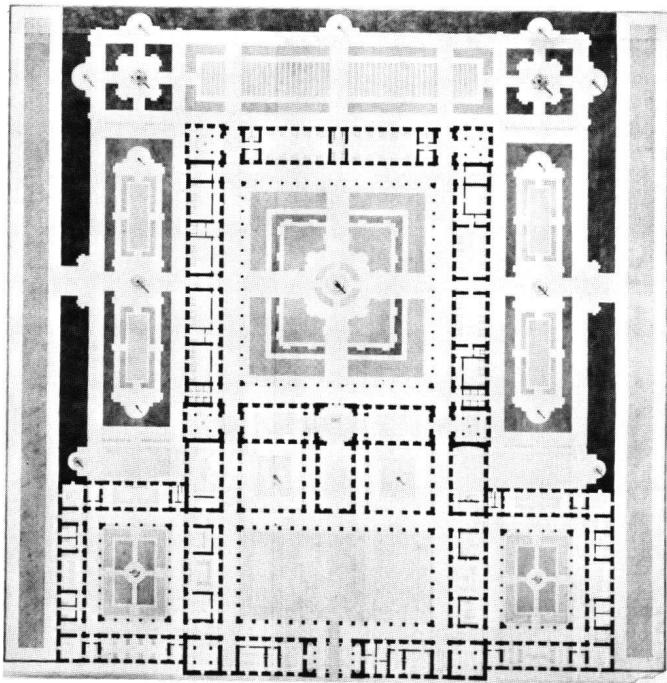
Concours pour un hospice de maternité. Plan du rez-de-chaussée, 3 juillet 1860.
